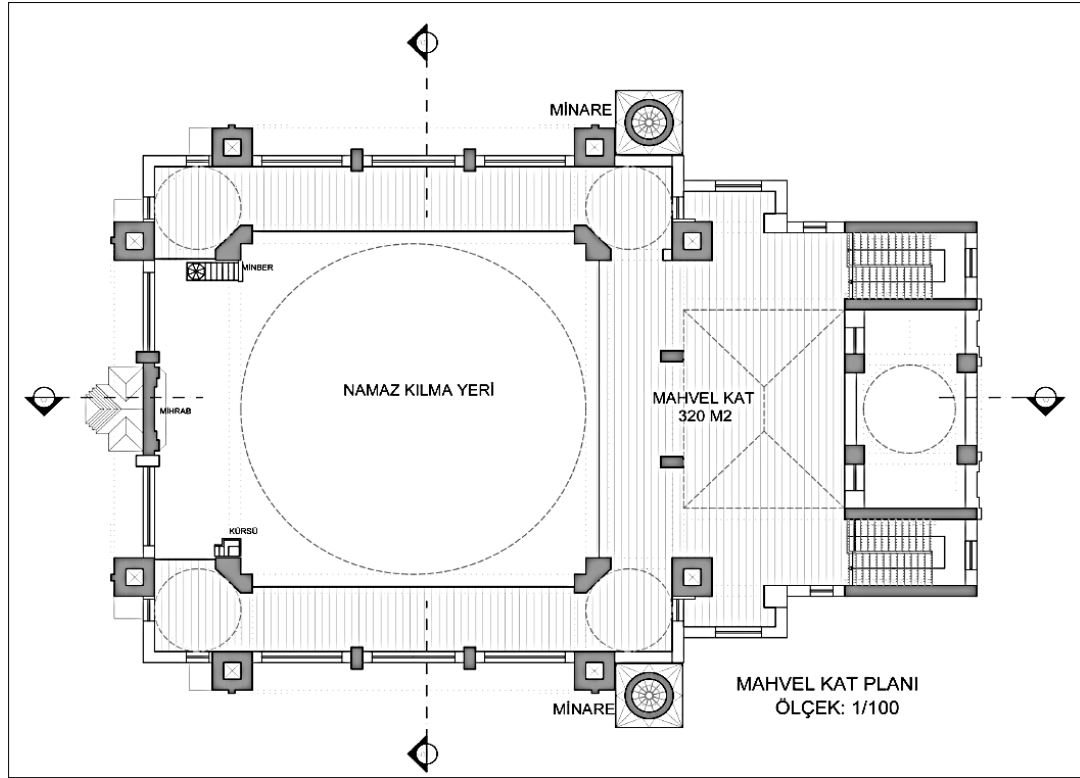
Hasan Tanık Cami vaziyet planı (Şahin, 2021)
